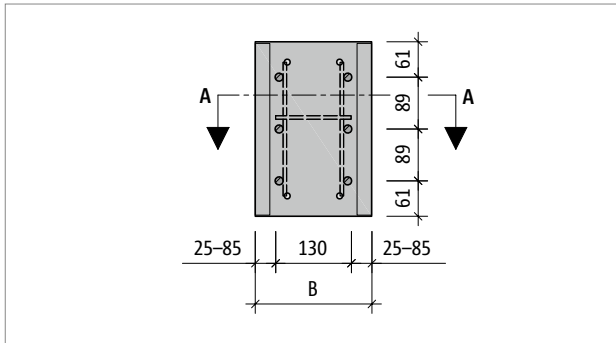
Schöck Sconnex® Typ W-T2: Produktgrundriss
